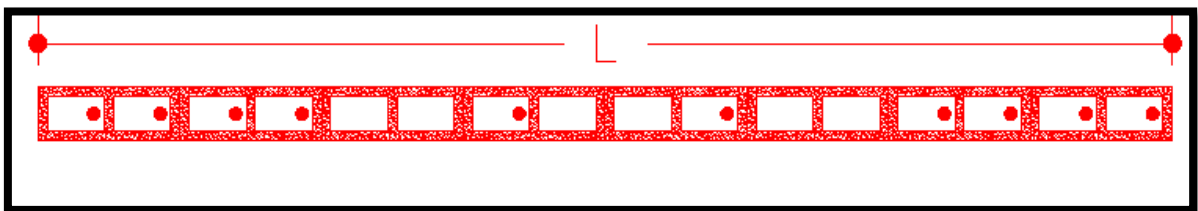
Vista de planta de Pared a analizar "A2 – A3" cuerpo 1.
